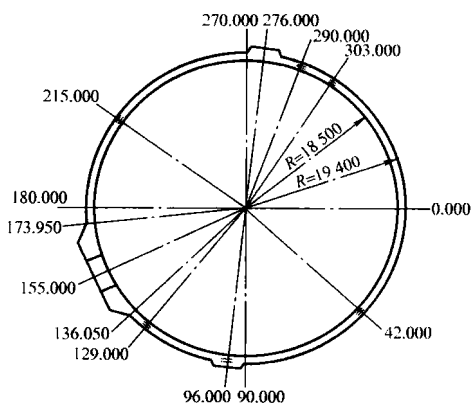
筒身中部 (26m) 应变传感器布置示意
